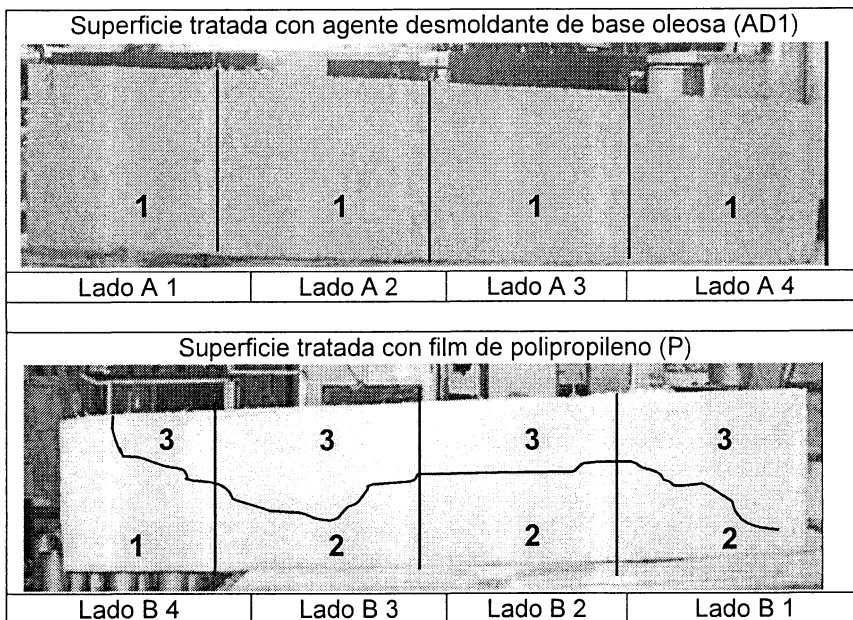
b. Relevamiento de burbujas en el panel llenado con el hormigón H2.
